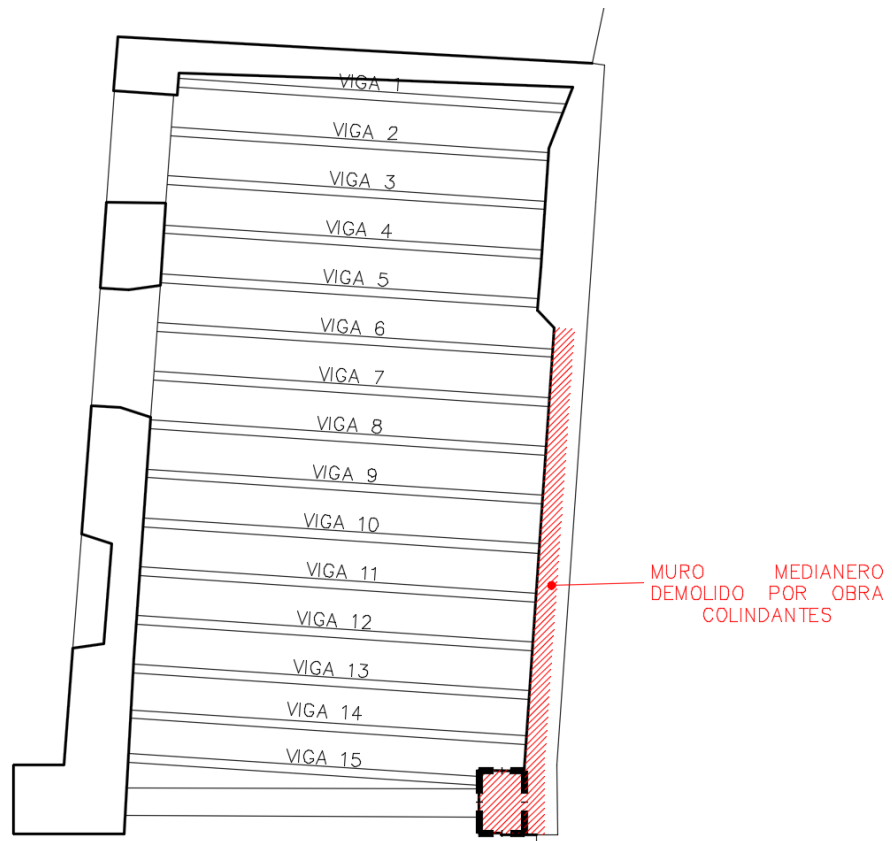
Plano de vigas de zona 2. Forjado de planta 1ª.
